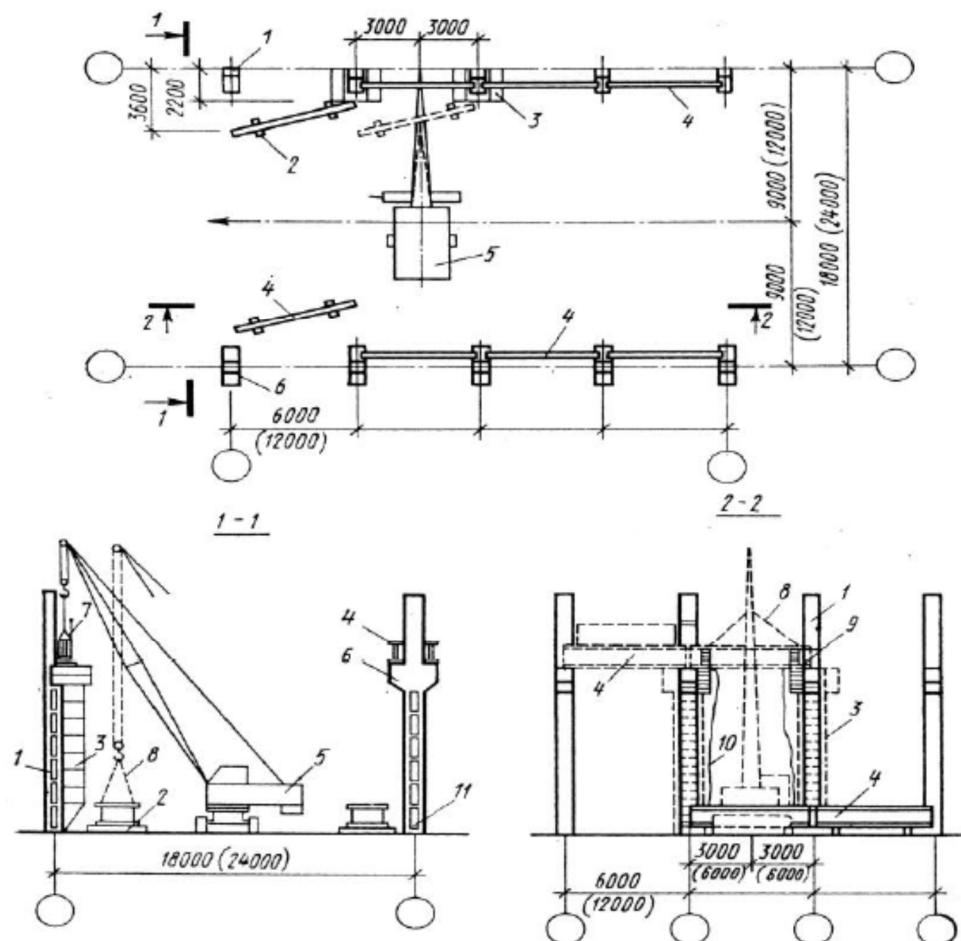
Схема установки подкрановых балок пролетом 6 и 12 м: 1 - колонна крайнего ряда; 2 - деревянная подкладка; 3 - приставная лестница; 4 - подкрановая балка; 5 - монтажный кран; 6 - колонна среднего ряда; 7 - стойка со страховочным канатом; 8 - строп; 9 - лестница монтажная; 10 - оттяжка из пенькового каната; 11 - место крепления приставной лестницы к колонне стальным канатом диаметром 13 мм.
